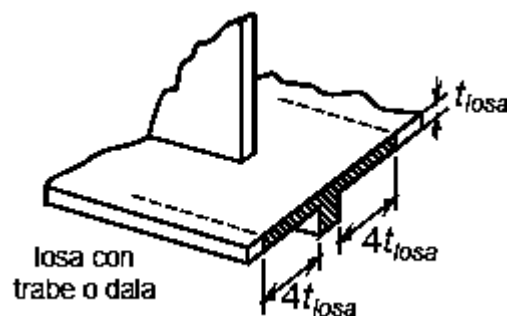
Ancho equivalente de losa con dala, (NTC-M, 2004).
